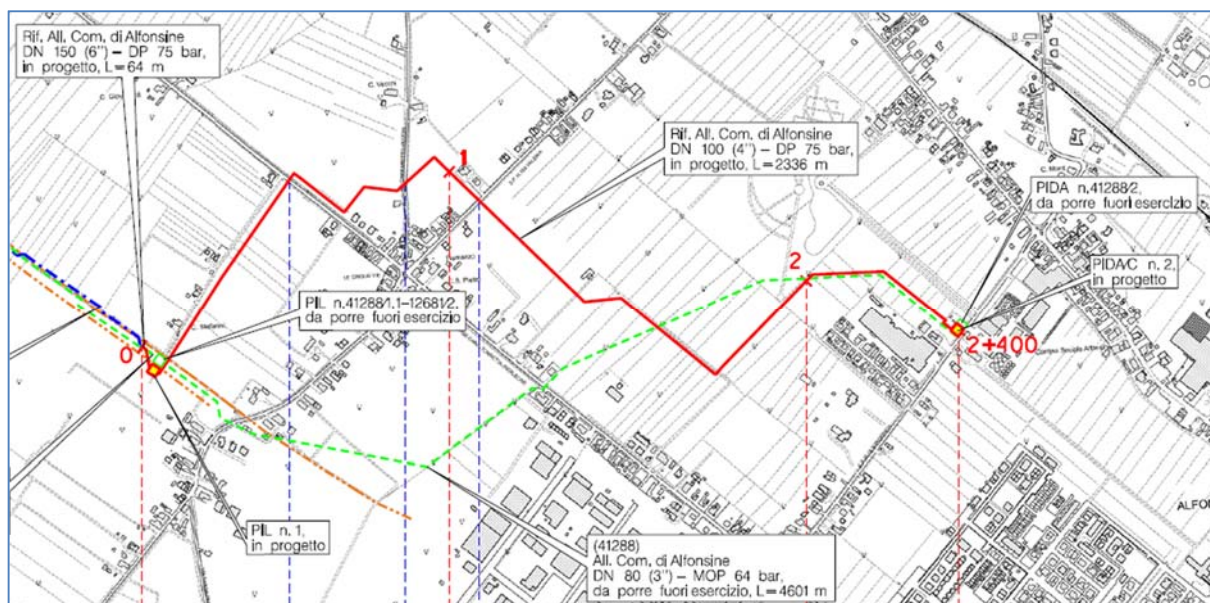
Stralcio planimetrico CTR con localizzazione del tracciato in progetto
